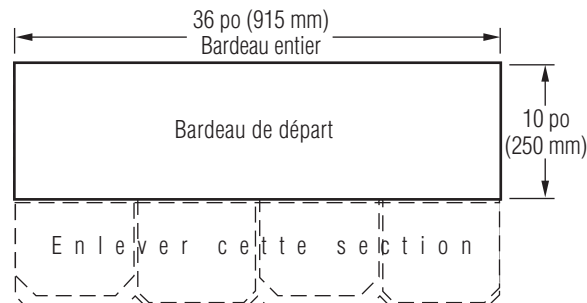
Fabriquer les bardeaux de départ en enlevant 8 po (203 mm) au bas des jupes.
